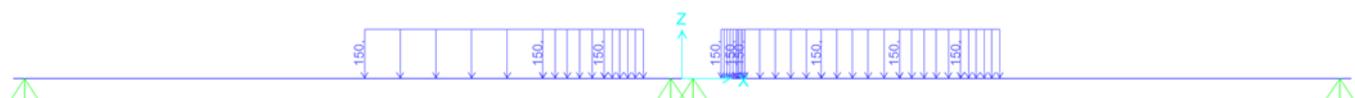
disposizione di carico 3 - SW/2 – pila 2
